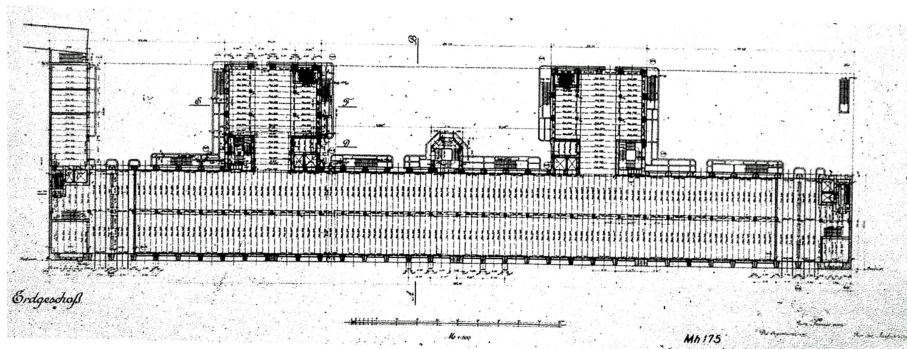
P. Behrens, *AEG Kleinmotorenfabrik*, Grundriss (urspr. Planungszust.)
